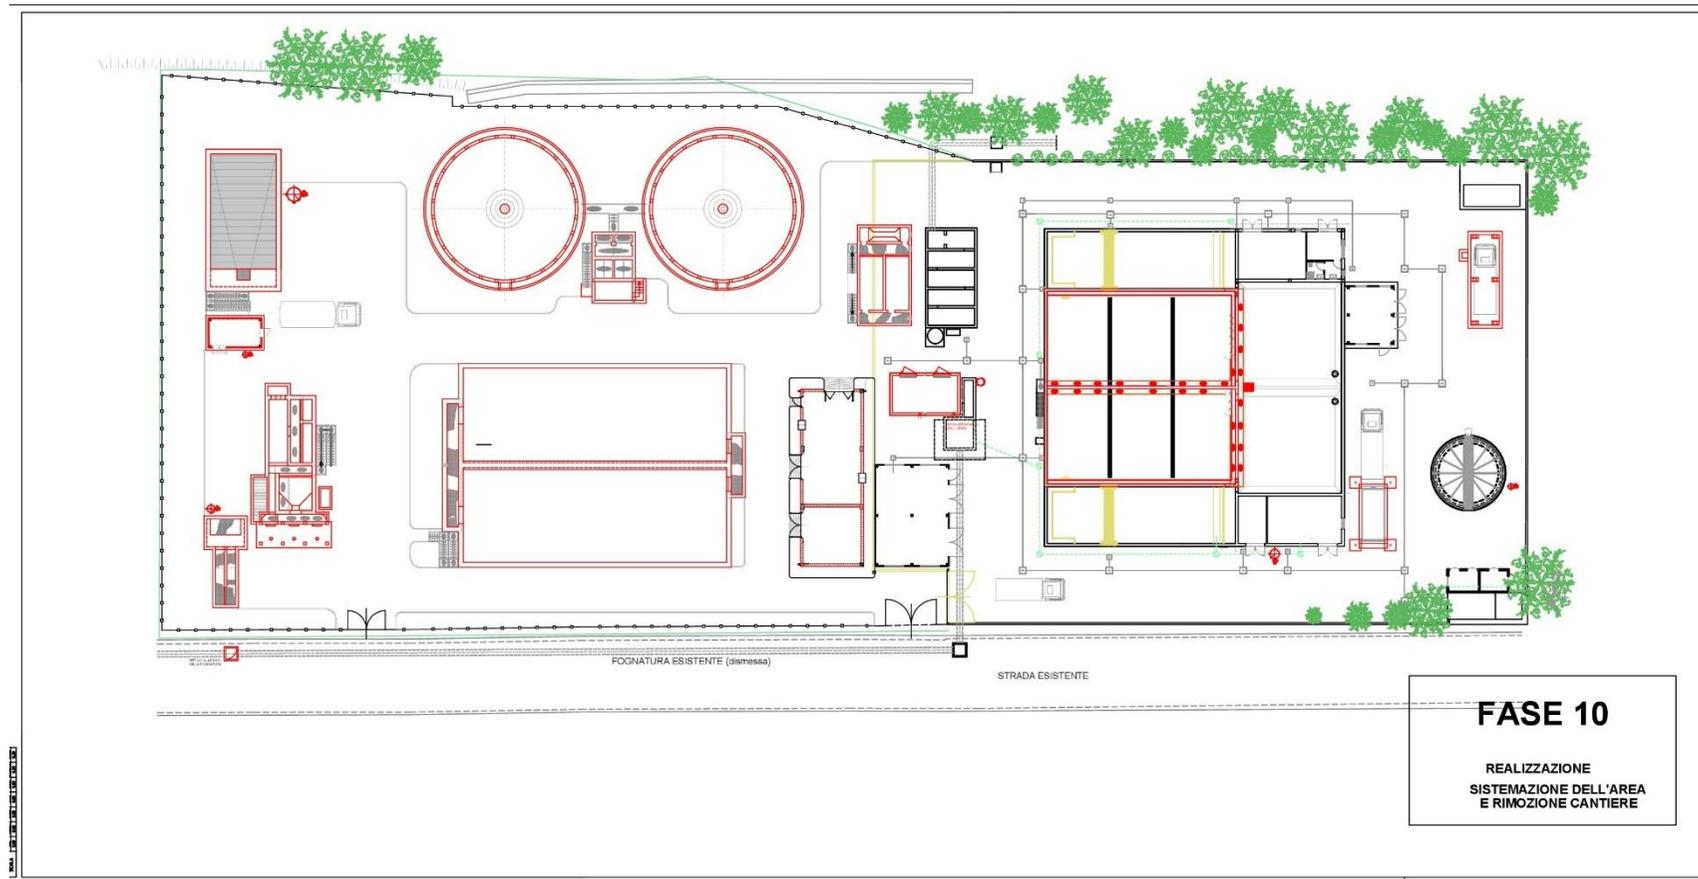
Fase 10 Sistemazione dell'area e rimozione cantiere
